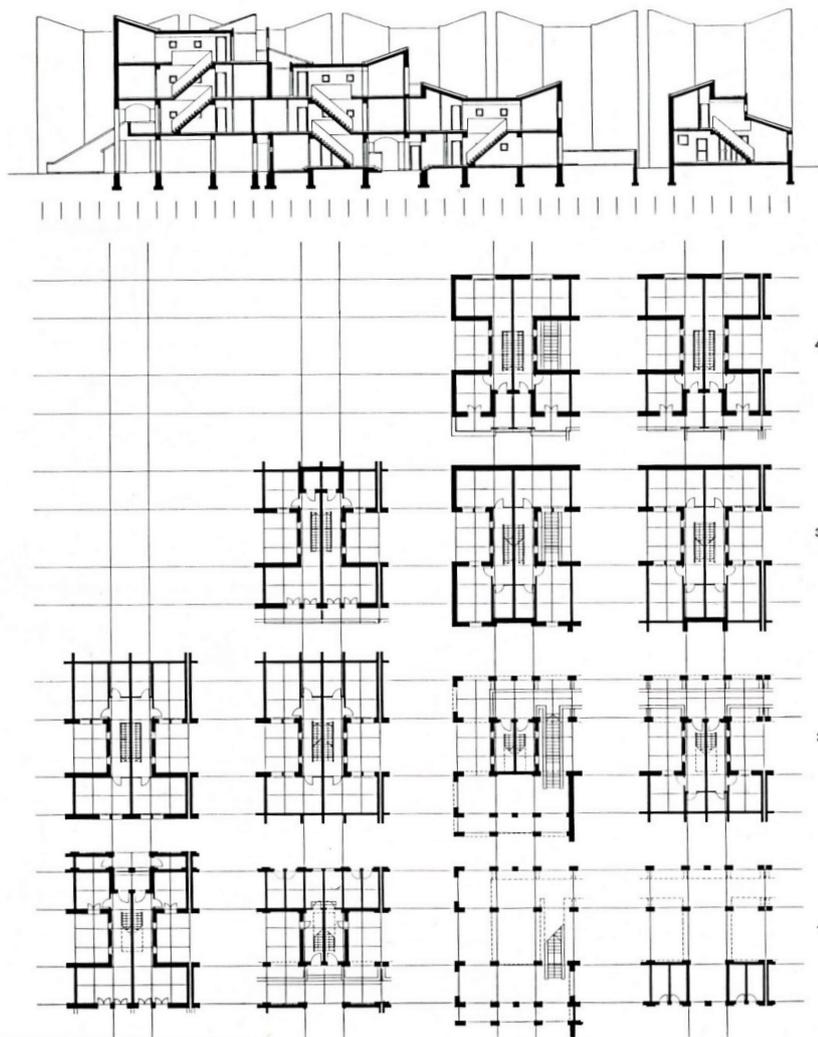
| Pianta e sezione nord-sud degli alloggi a tappeto e a schiera
